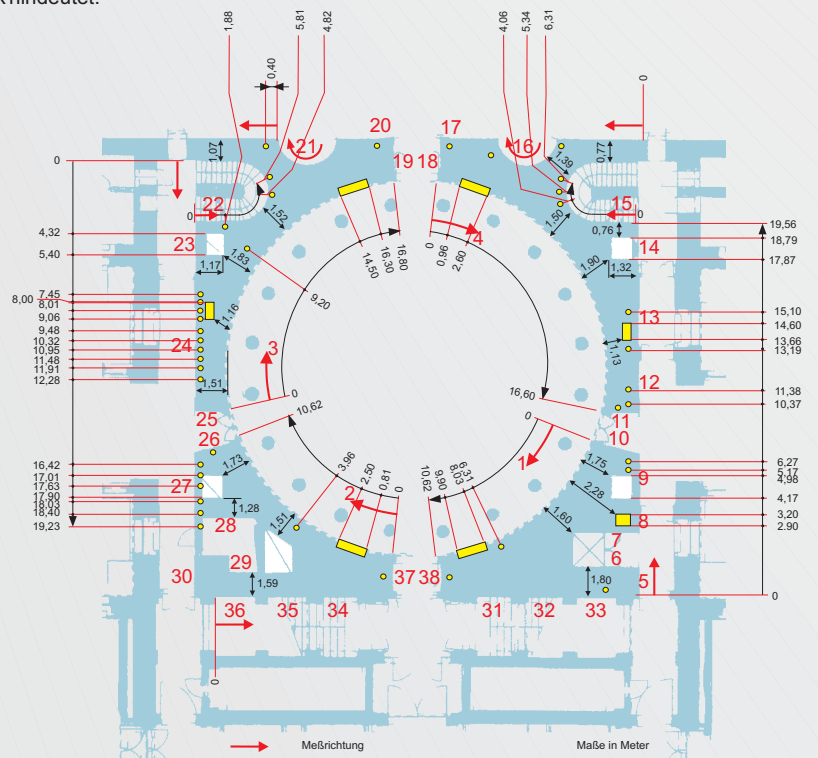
Grundriß der Rotunde mit Meßspuren und Hohlstellen.
